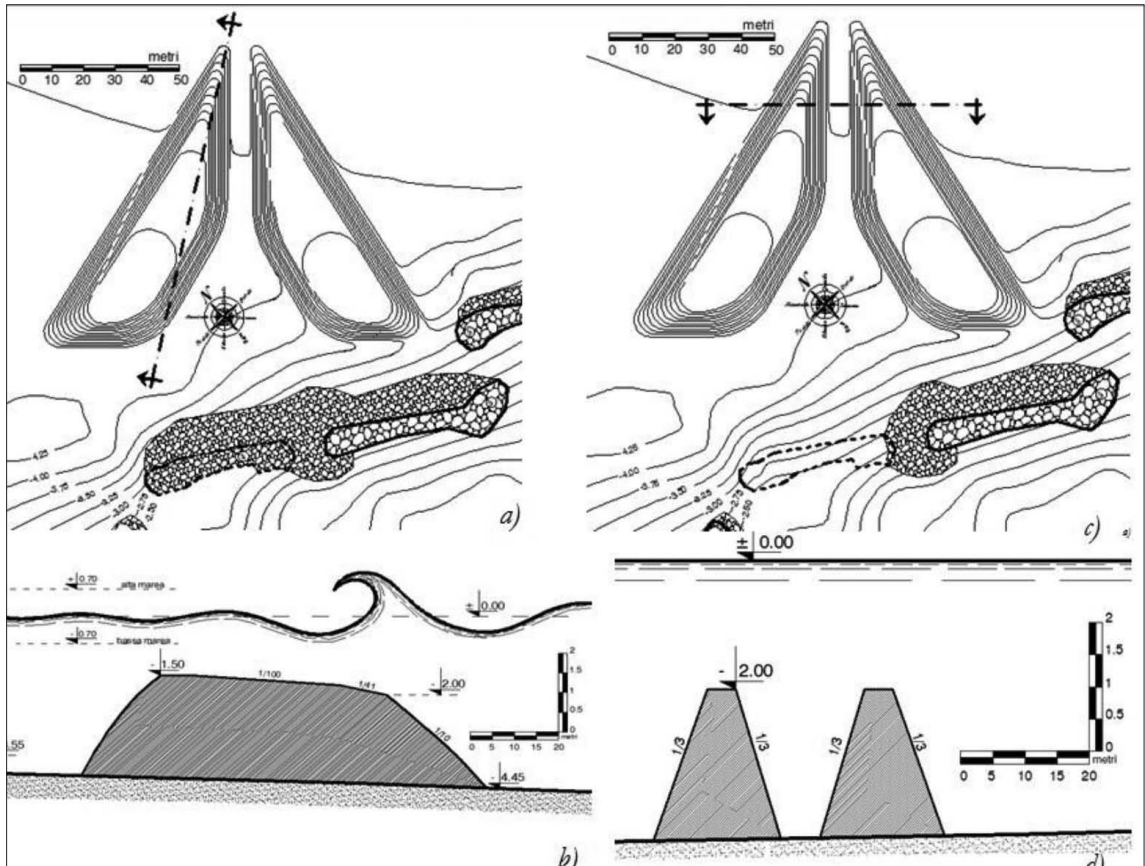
Planimetrie e profili altimetrici della prima ipotesi a) e b) e della seconda ipotesi c) e d).
